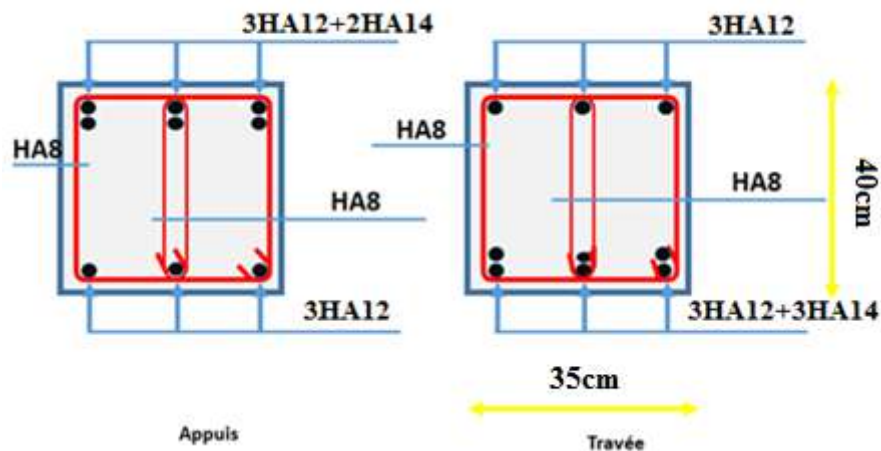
ferrailage de la poutre principale plancher terrasse.
